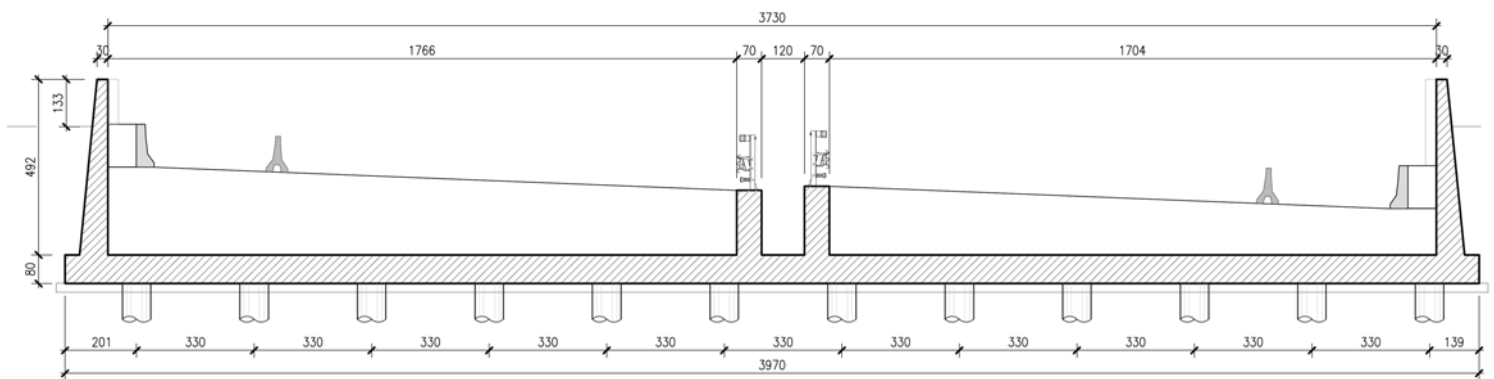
SEZIONE TRASVERSALE DI CALCOLO 1 (SEZIONE K14).
